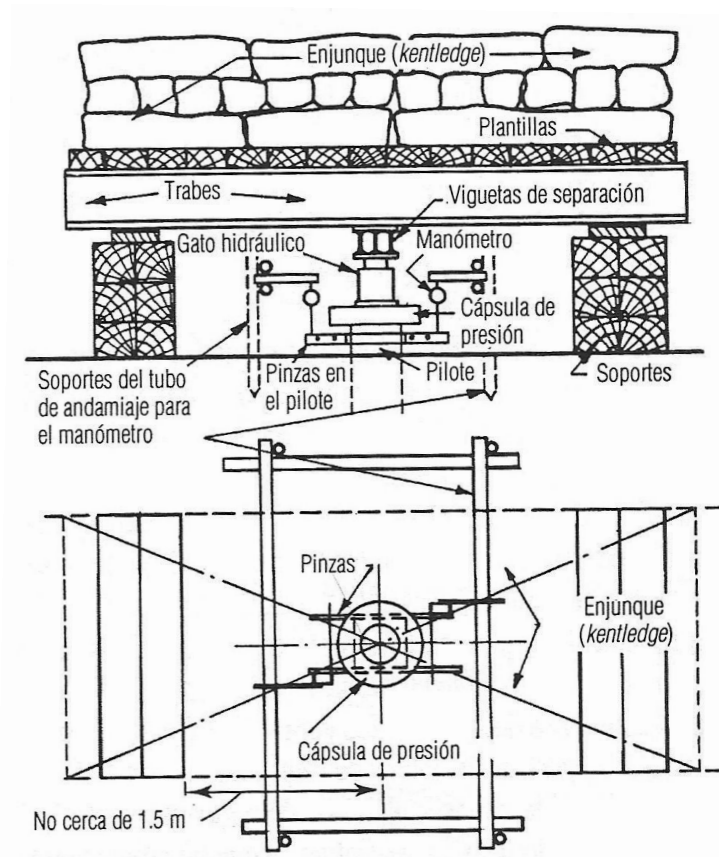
Disposición del aparato de la prueba de carga para los pilotes.
